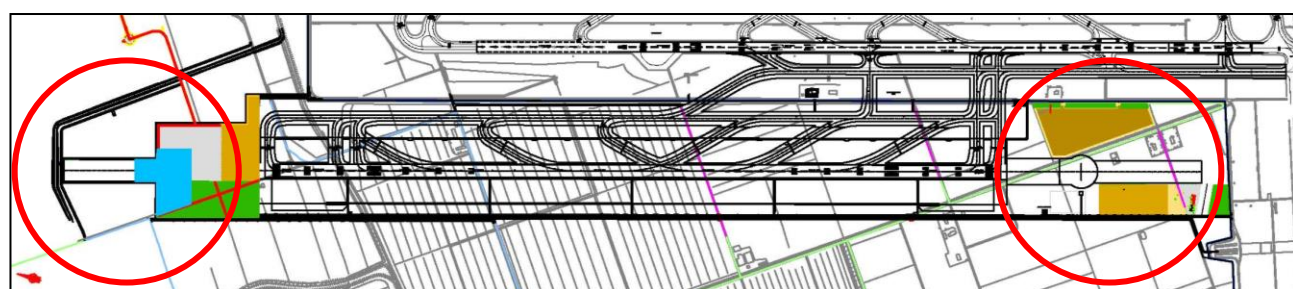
Planimetria delle aree di cantiere di Pista 16R/34L.
